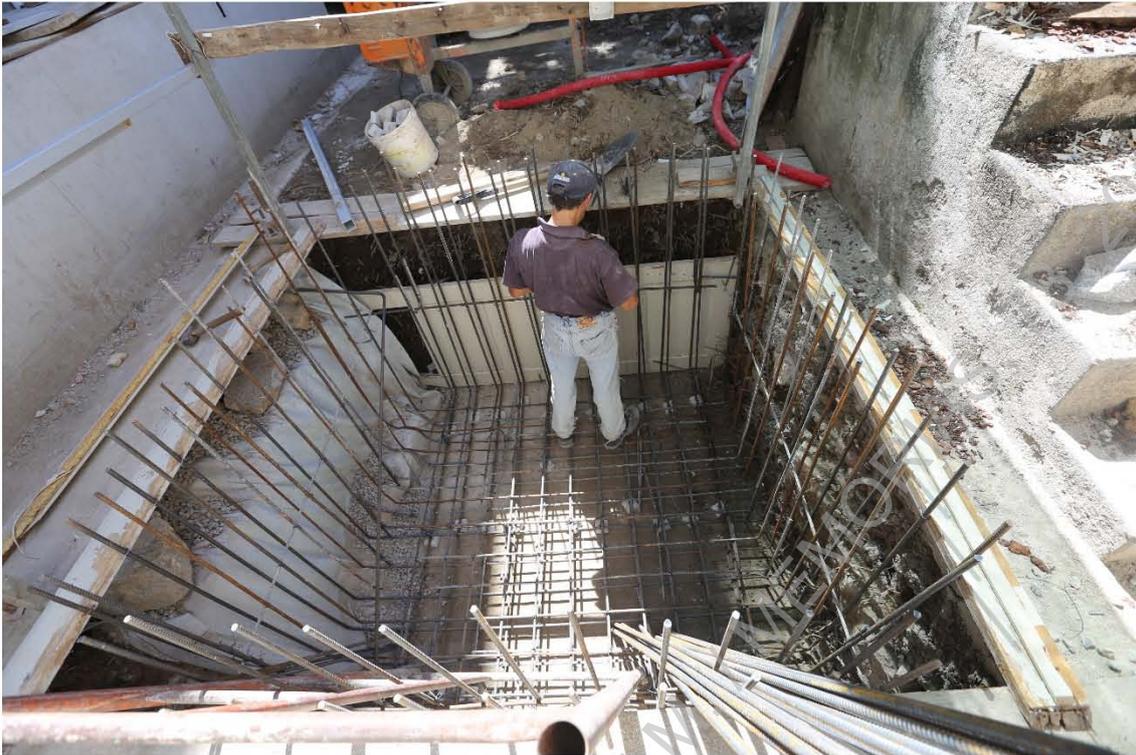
(BRA16REQ98\_IMG\_8393) – Perspetiva geral do perfil oeste (E/O).
